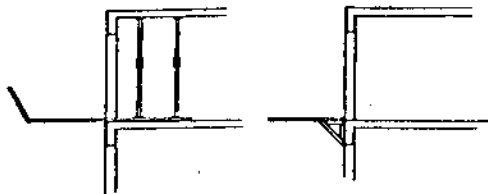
Tipos de Plataformas para o Recebimento dos Tijolos no Pavimento.
